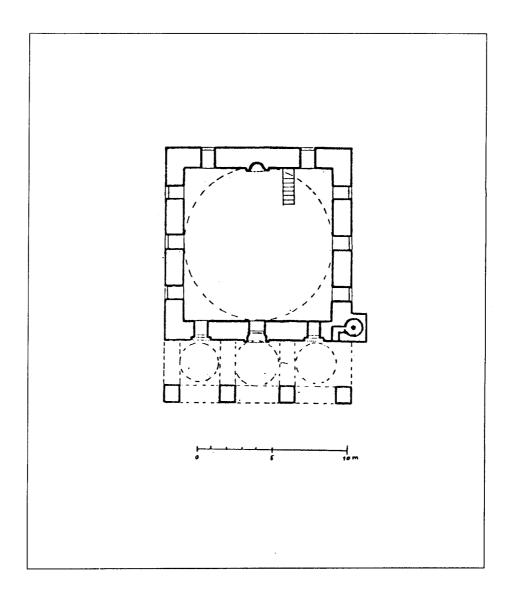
مسقط أفقي وقطاع لمسجد يحيى باشا في اسكوب (عن : ايفردى) .
